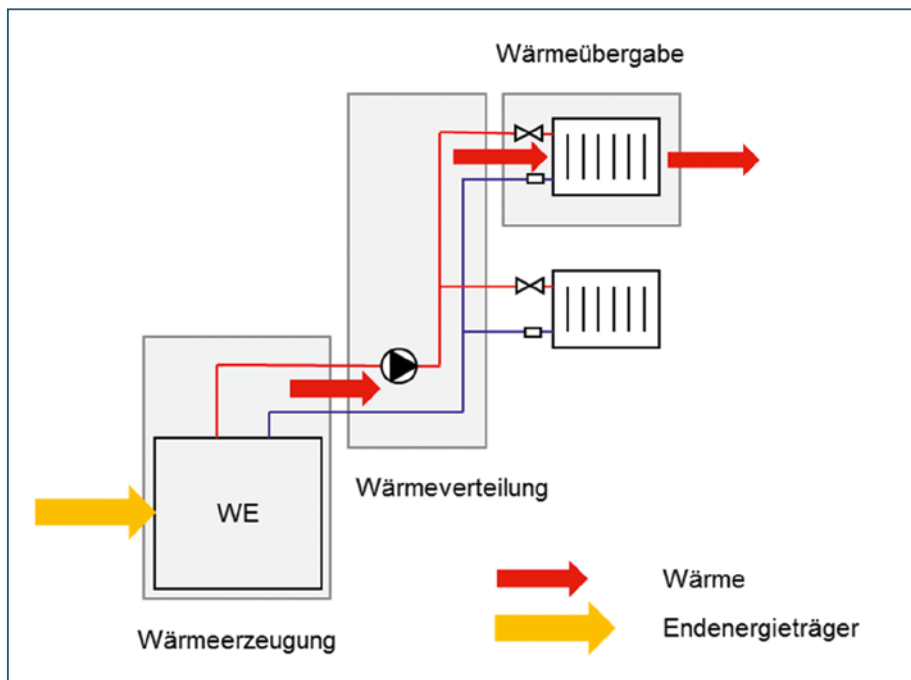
Funktionale Struktur einer Heizungsanlage
